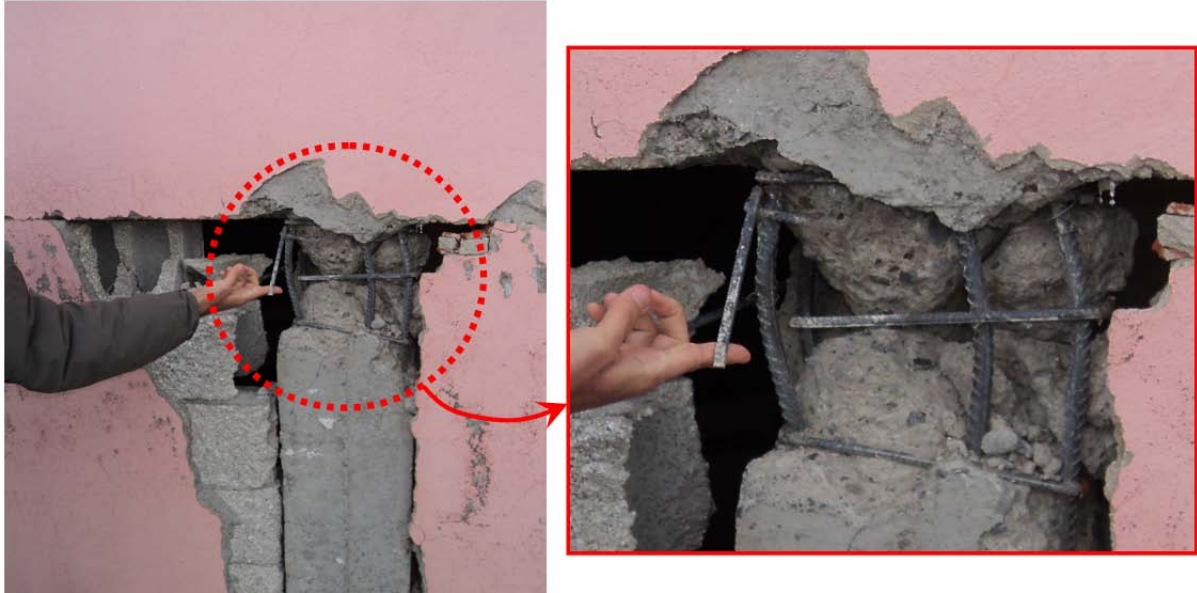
Kolon alt ucunda etriye sıklaştırması yapılmaması
